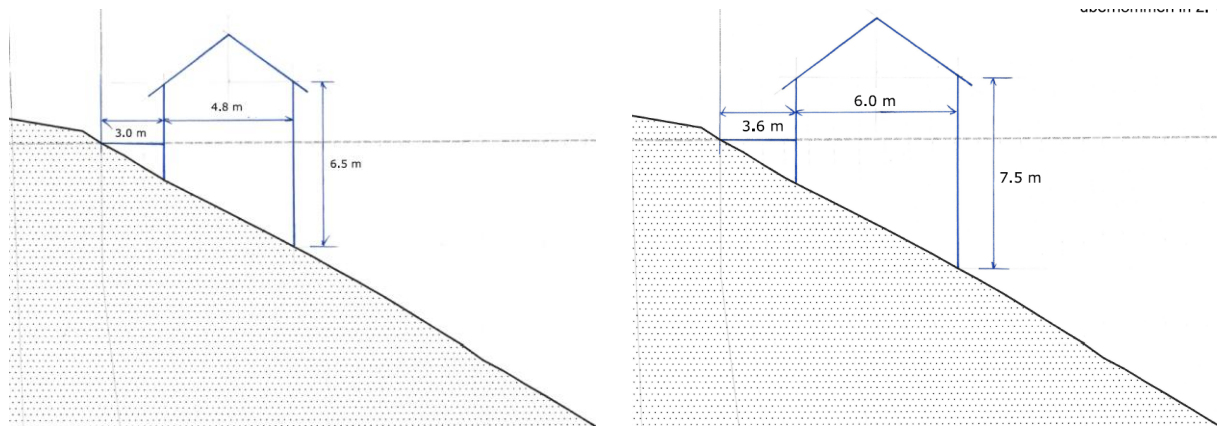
Fassadenhöhe und Hangzuschlag gem. Forderung AGR (links) und Vorschlag Gemeinde (rechts)
